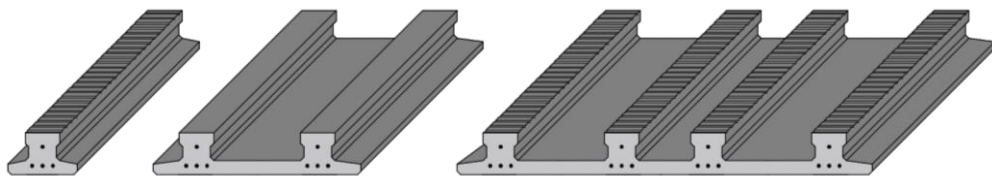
Widok stropu TERIVA PANEL: 1 – strunobetonowy panel stropowy z wypełnieniem z betonu lekkiego, 2 – zbrojenie wieńców, 3 – uzupełniający beton wieńców i zamków układany na budowie
